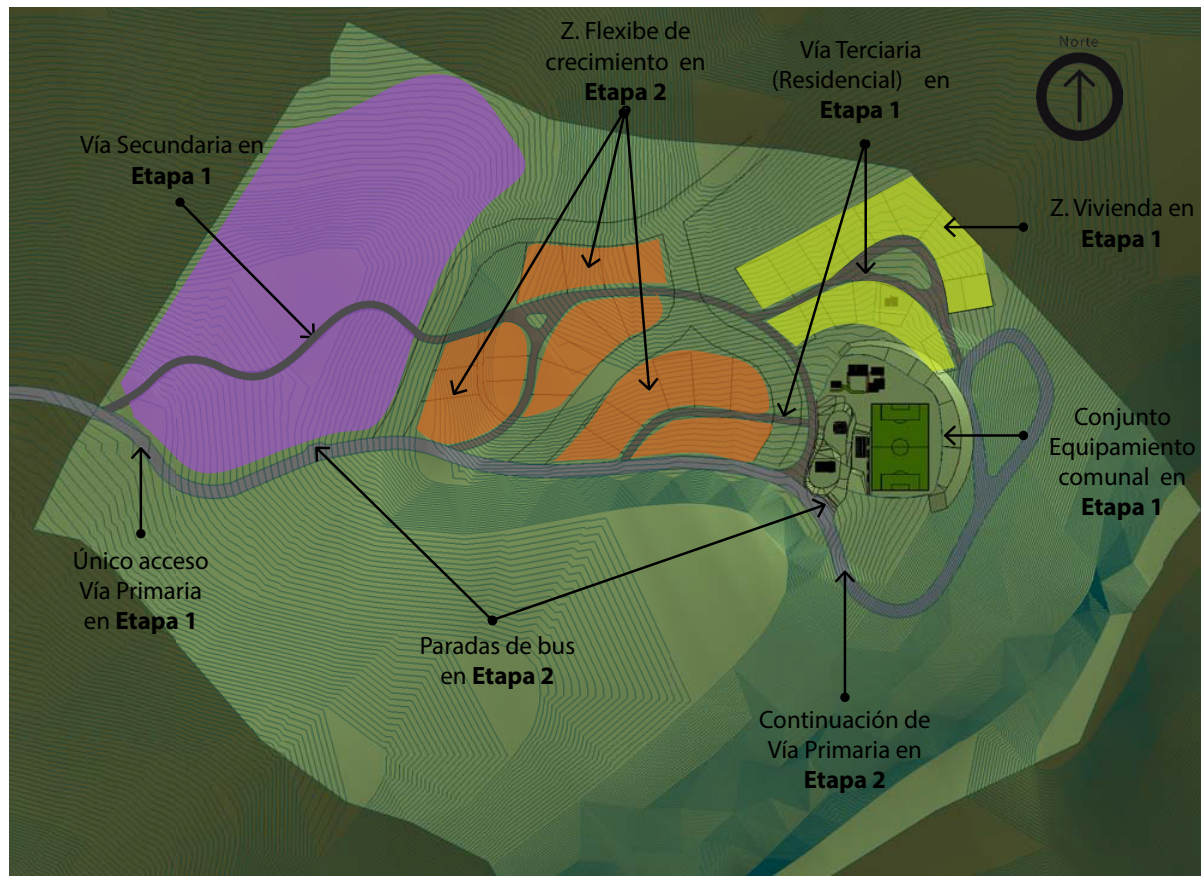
14. Plano del Plan maestro. Elaboración propia.
